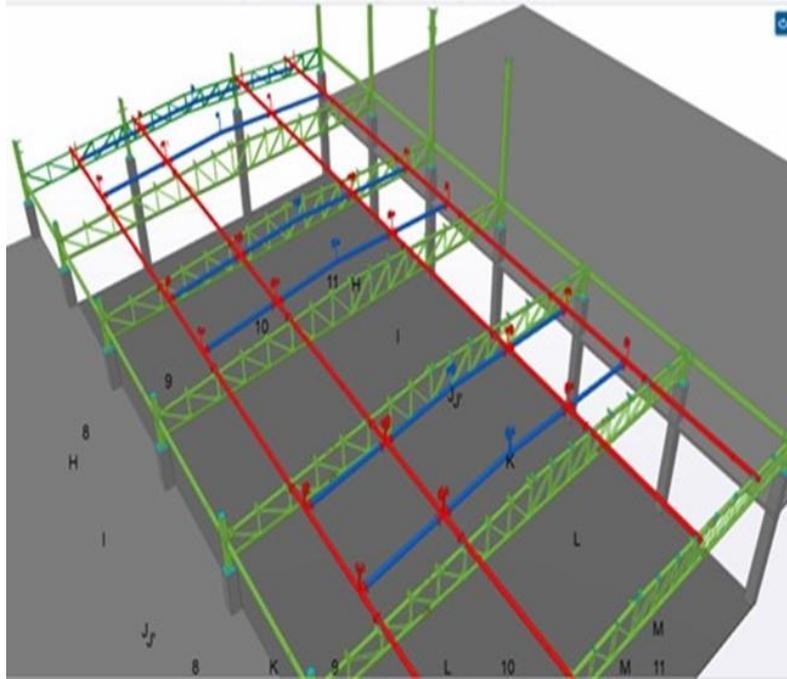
Montaje de vigas tubulares entre el eje N-M
